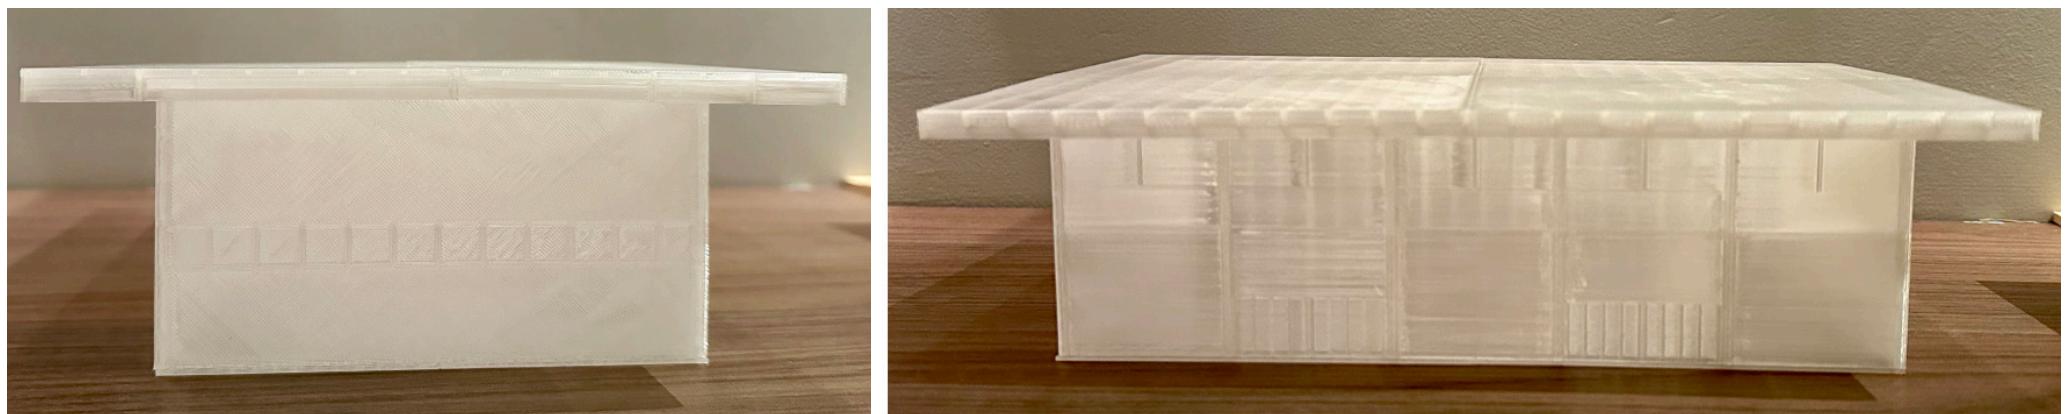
Maquete impressa em impressora 3D e montada. (a) Fachada Oeste (b) Fachada Sul. Fonte: Autora.
